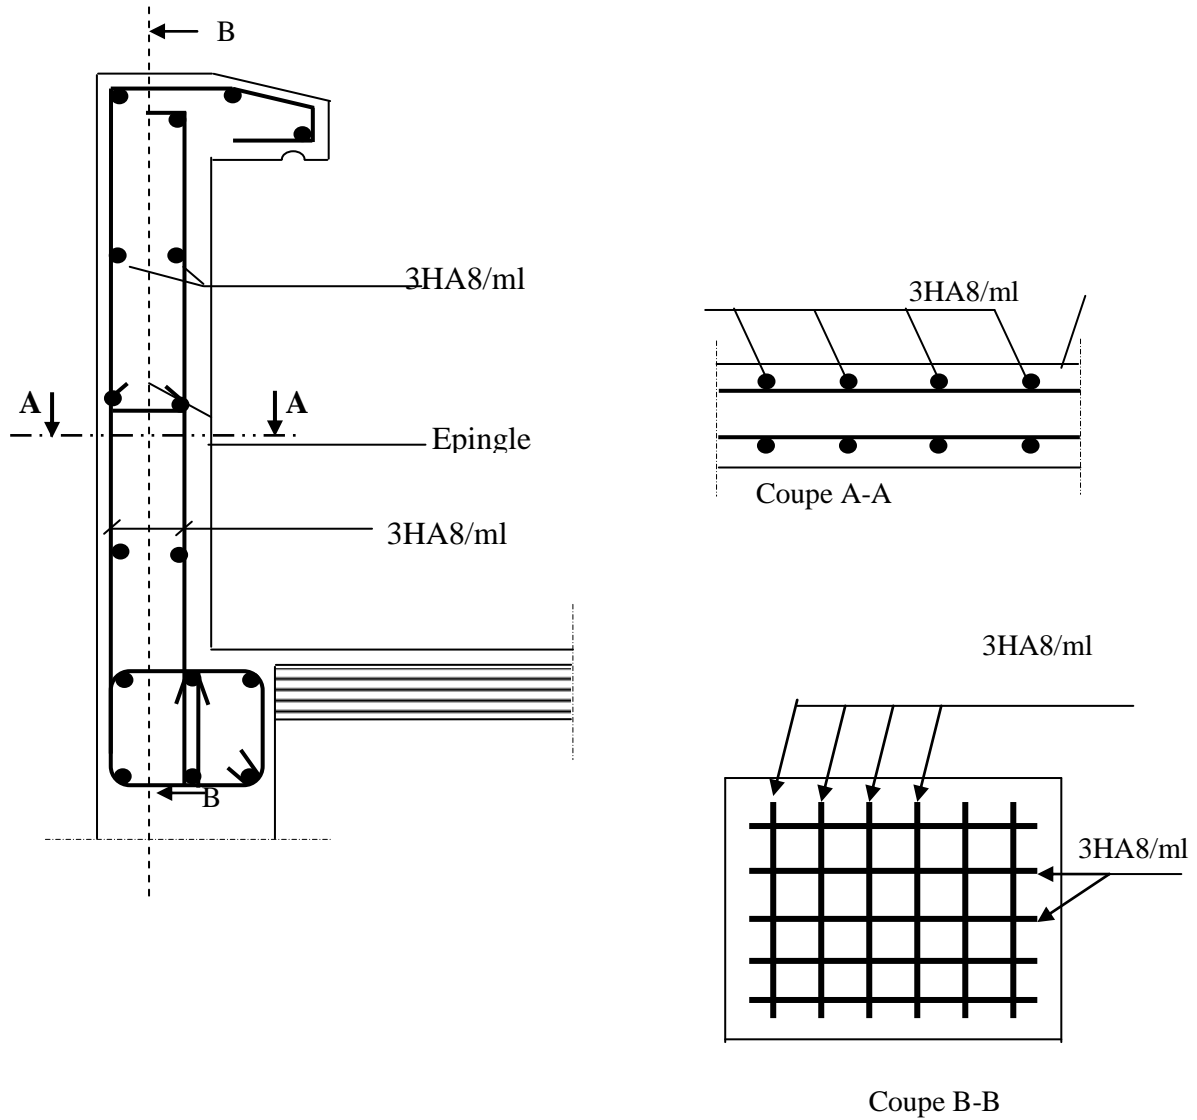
Plan de Ferrailage de l'acrotère.
